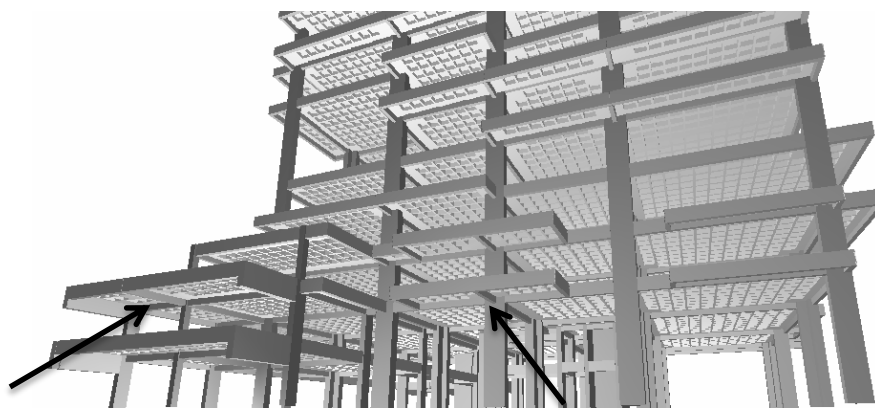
Região do modelo estrutural, da Solução com Laje Nervurada, onde foram introduzidas novas vigas em balanço
